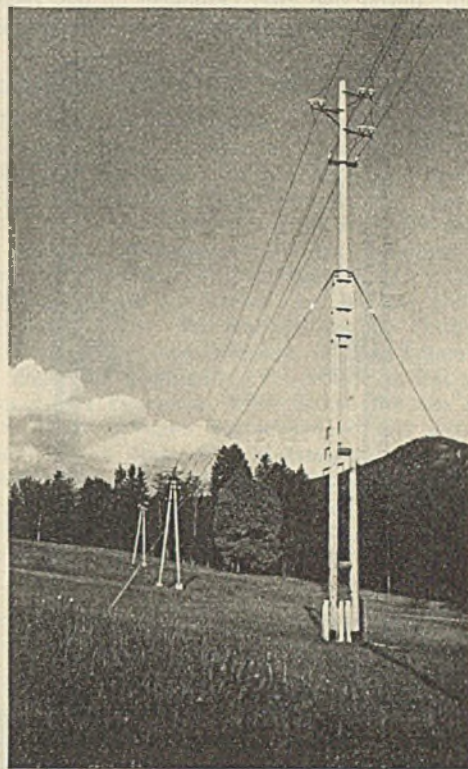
Holzmastkonstruktion für Sumpfstrecken.
